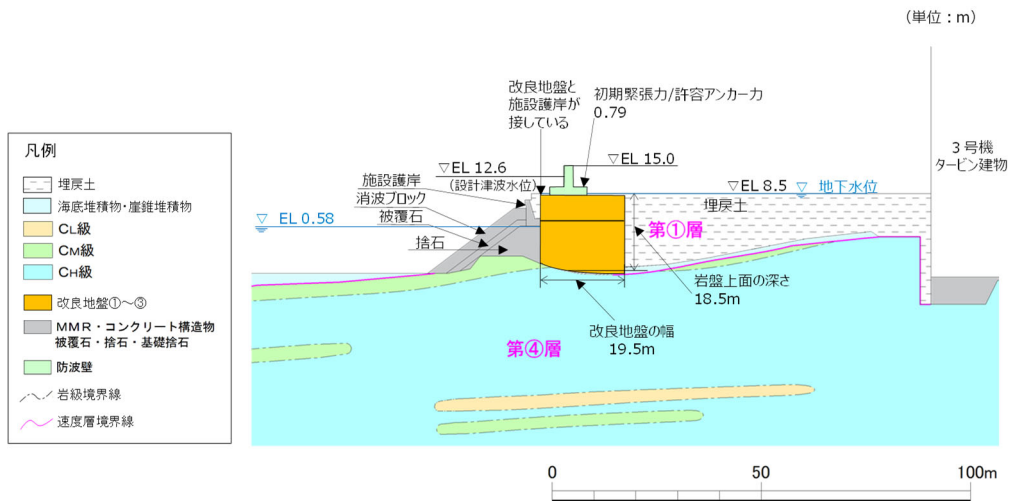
防波壁（逆 T 擁壁）の横断面図（⑤-⑤断面）
